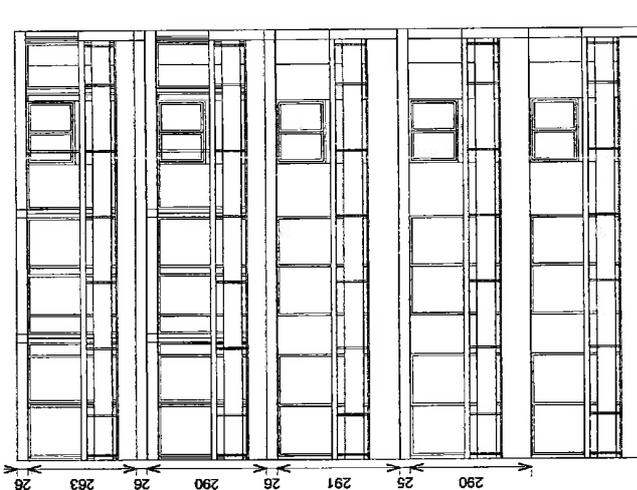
Élévation du bâtiment / Fournis par la maîtrise d'ouvrage
